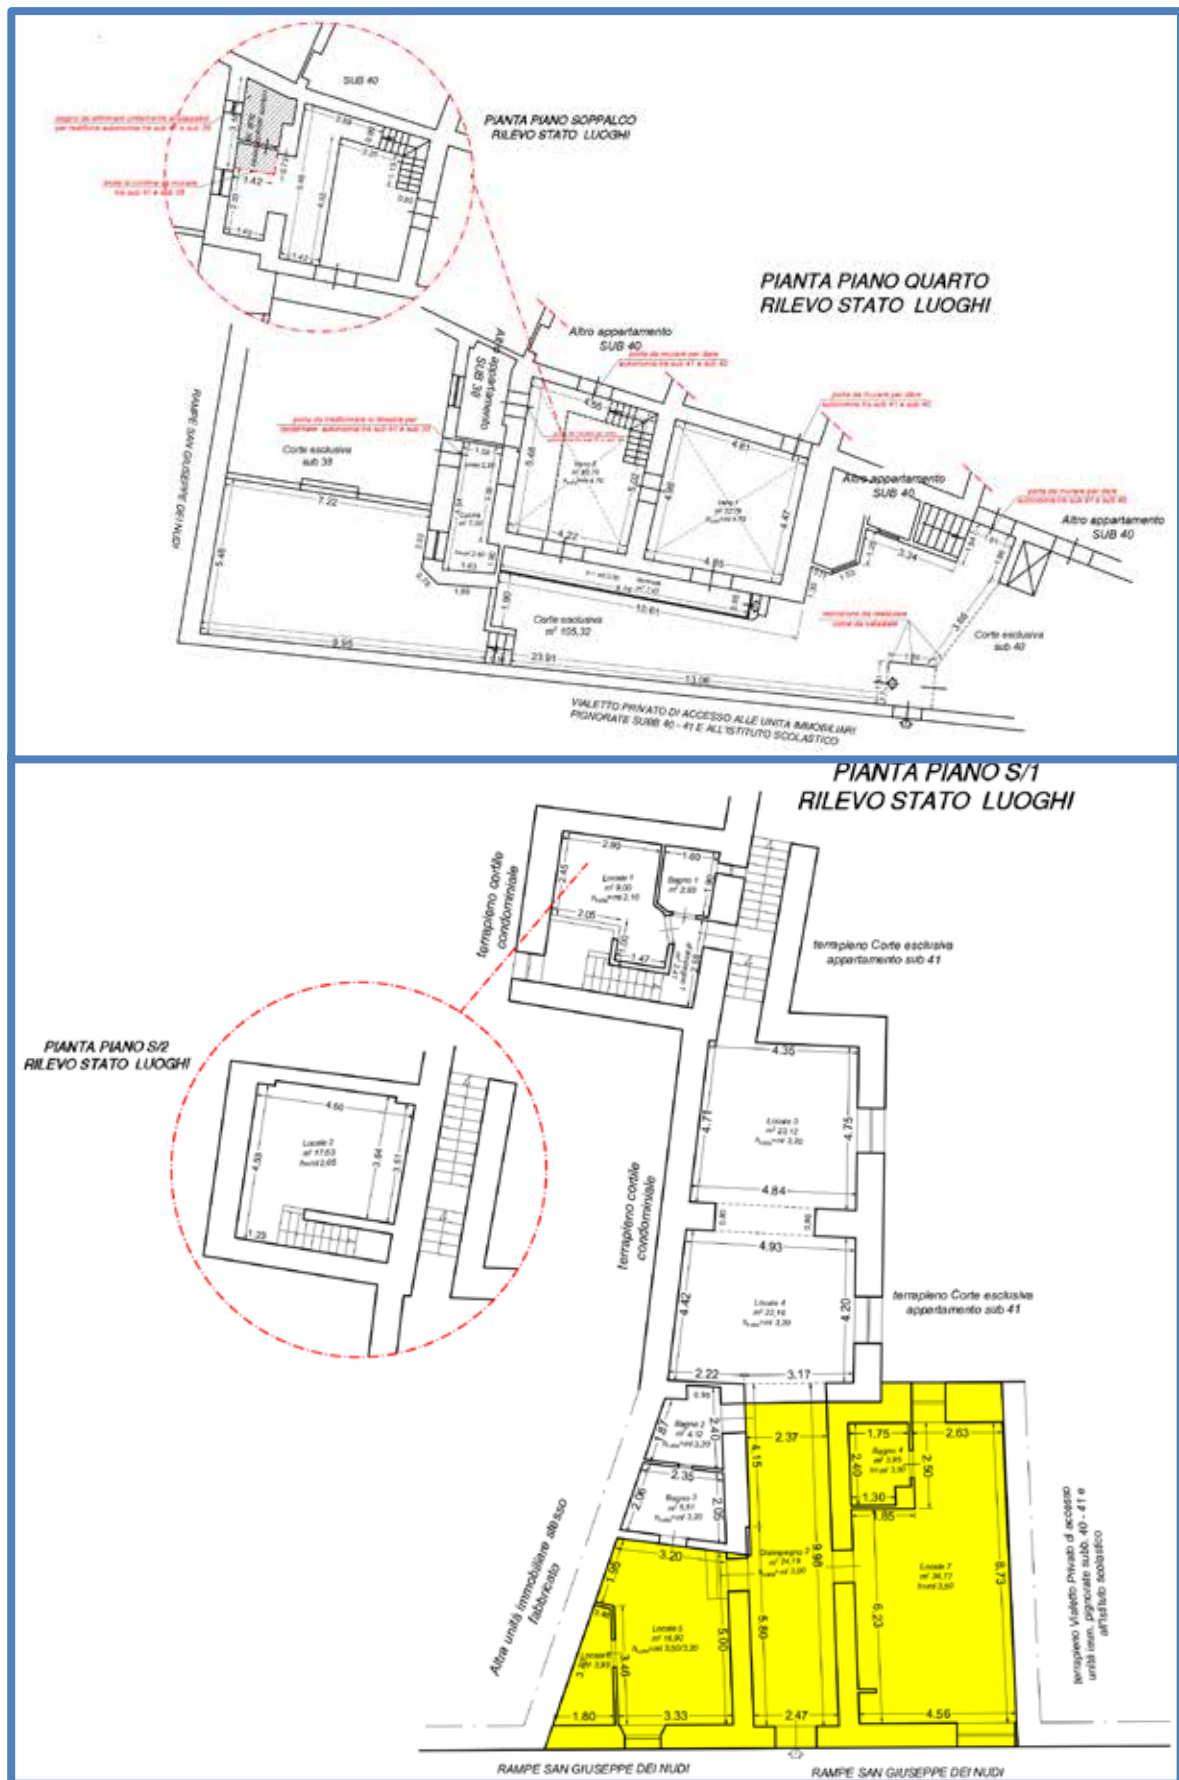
Planimetria del rilievo dello stato dei luoghi appartamento sub 41.
